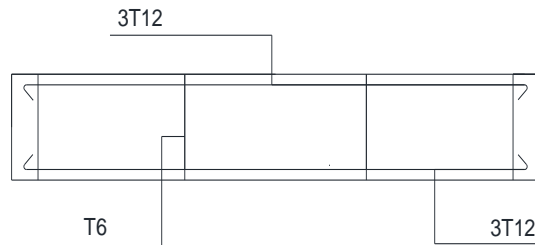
Coupe longitudinale d'une poutre noyée secondaire 15x20cm (bâtiment R+3)
